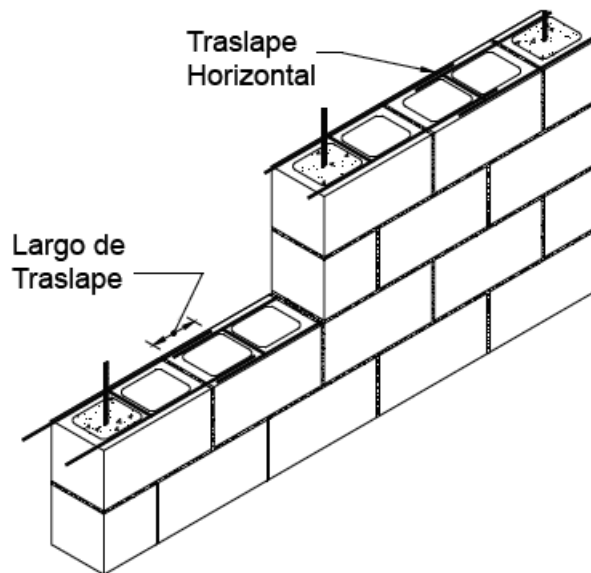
Empalme por traslape de escalerillas electrosoldadas. Largo de traslape para efectos de la contracción por secado de la albañilería (NCMA, 2005)
